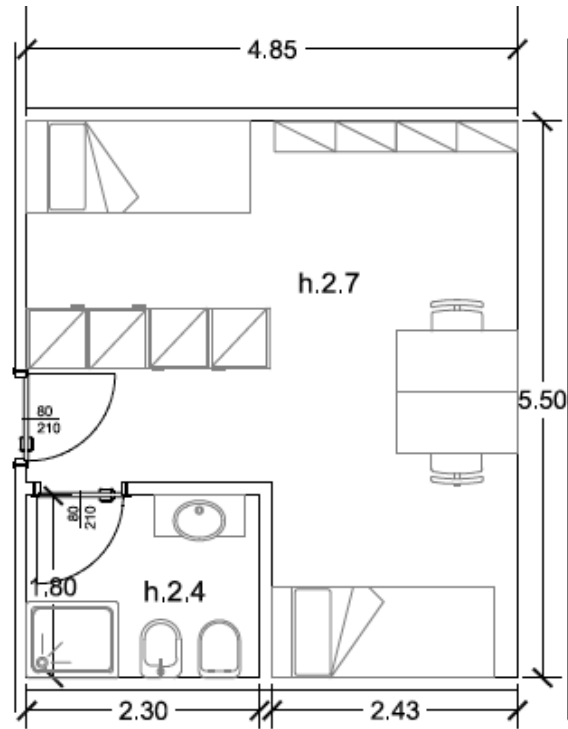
4 – Pianta tipo alloggio in camera doppia - Fonte: elaborazione dell'autore
